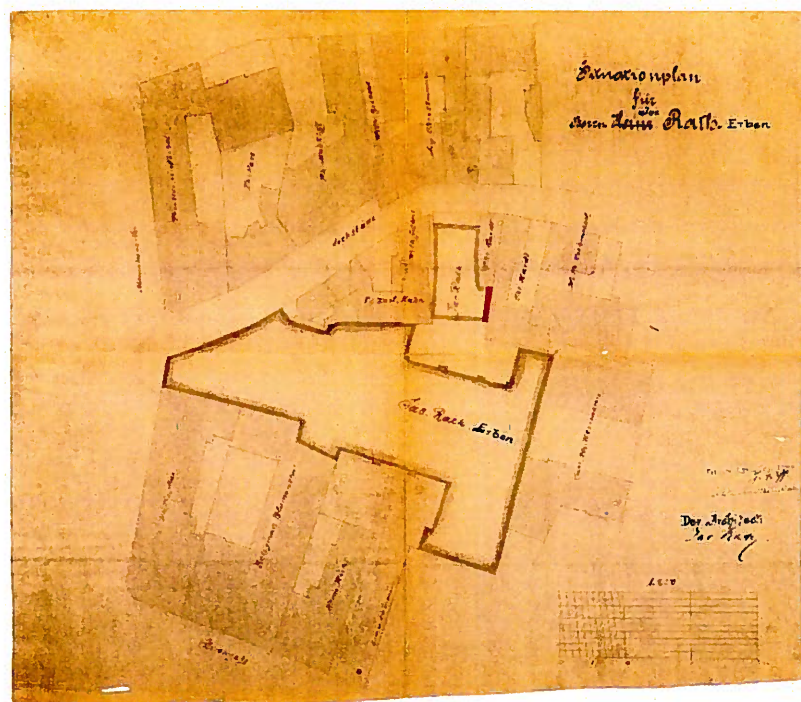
Wiesbaden, Situationsplan für Jac. Rath Erben, 1898, Bauakte Stadt Wiesbaden
